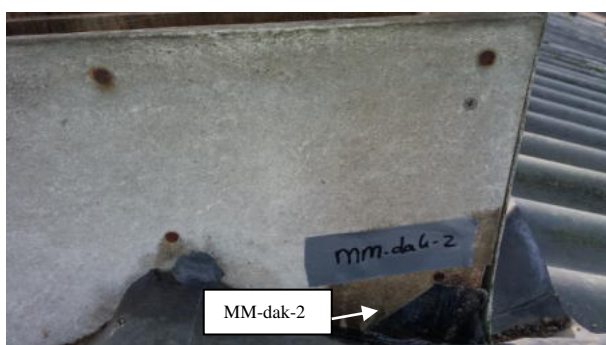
Asbesthoudend plaatmateriaal aan ventilatiekokers van kalverstal.
